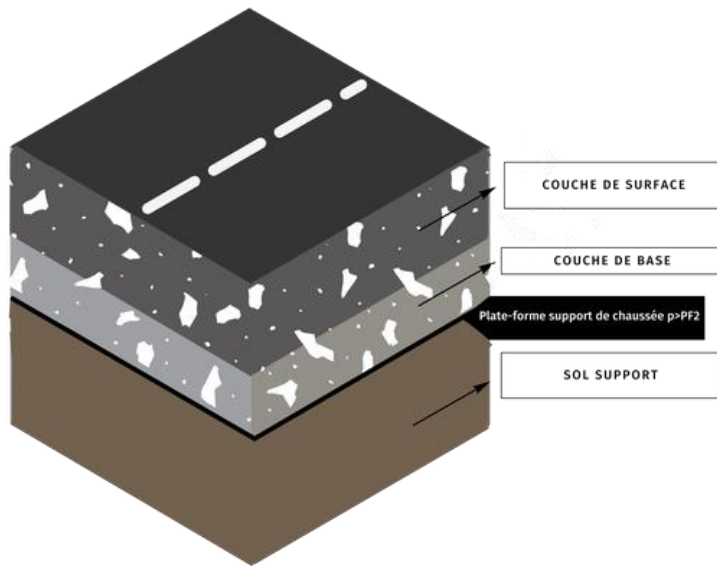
Différentes Couches Constituant La Structure De La Chaussée
